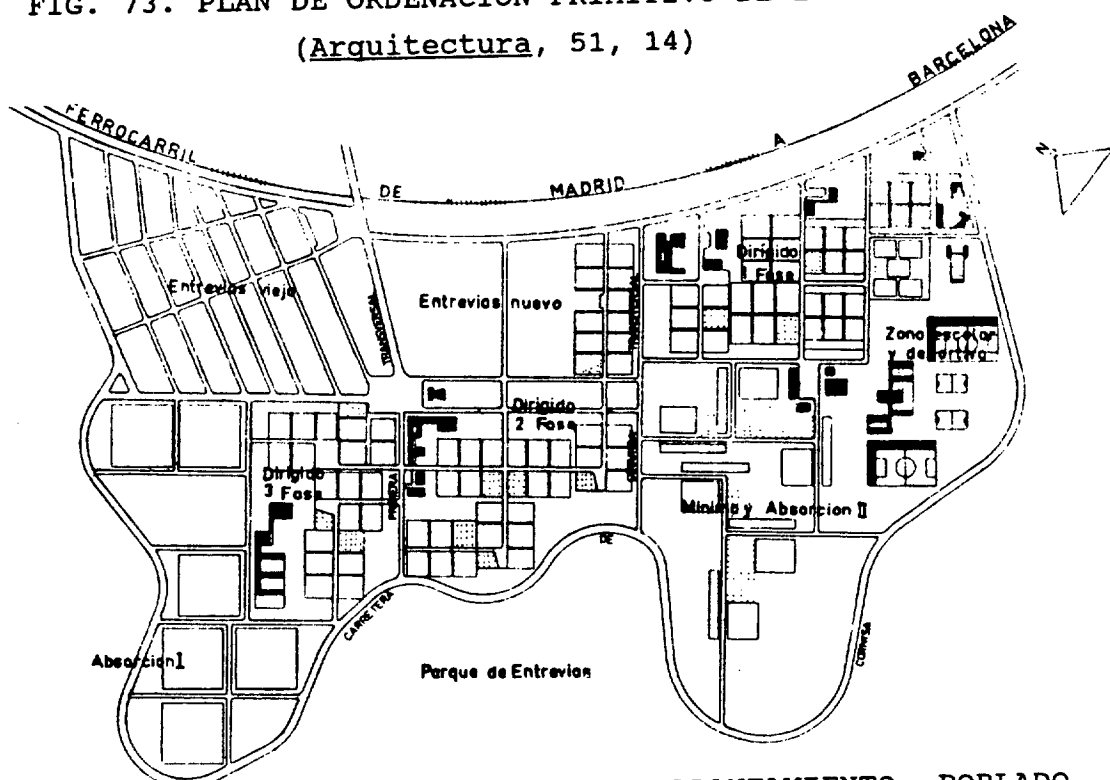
PLAN DE ORDENACION PRIMITIVO DE ENTREVIAS
